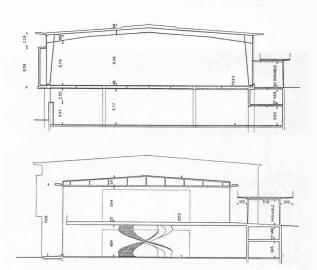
Coupes sur l'un des pavillons sud. Echelle $\mathbf{1}:600.$
